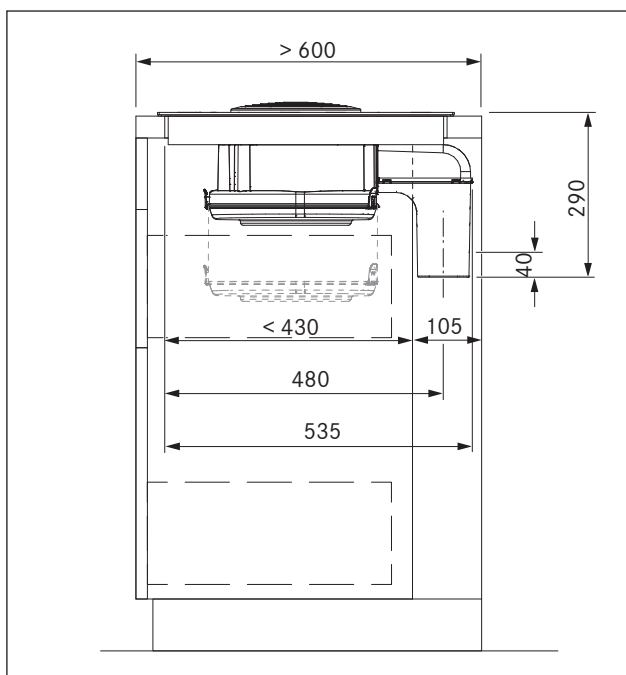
Cotes de montage en mode évacuation d'air, profondeur du plan de travail 600 mm
